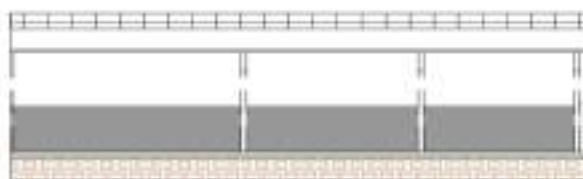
Indicação em cinza escuro da faixa de reboco da alvenaria que será implantada após retirada dessa argamassa antiga
